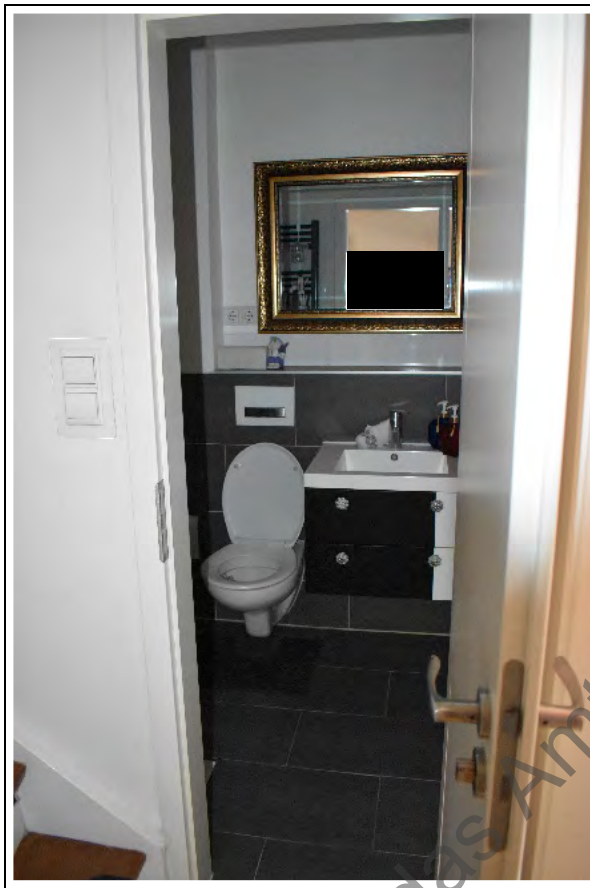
OG, Bad mit Unterschrank und integriertem Waschbecken
